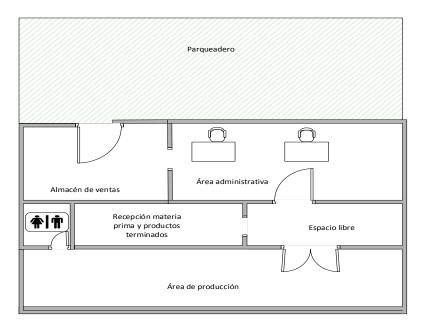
Plano de planta Figura: Plano de la planta. Elaborado: Jessica Vinueza
